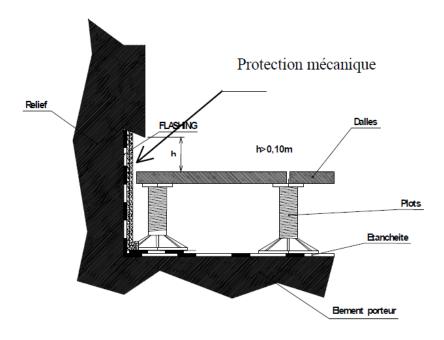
Niveau fini des dalles au- dessous du haut des relevés
